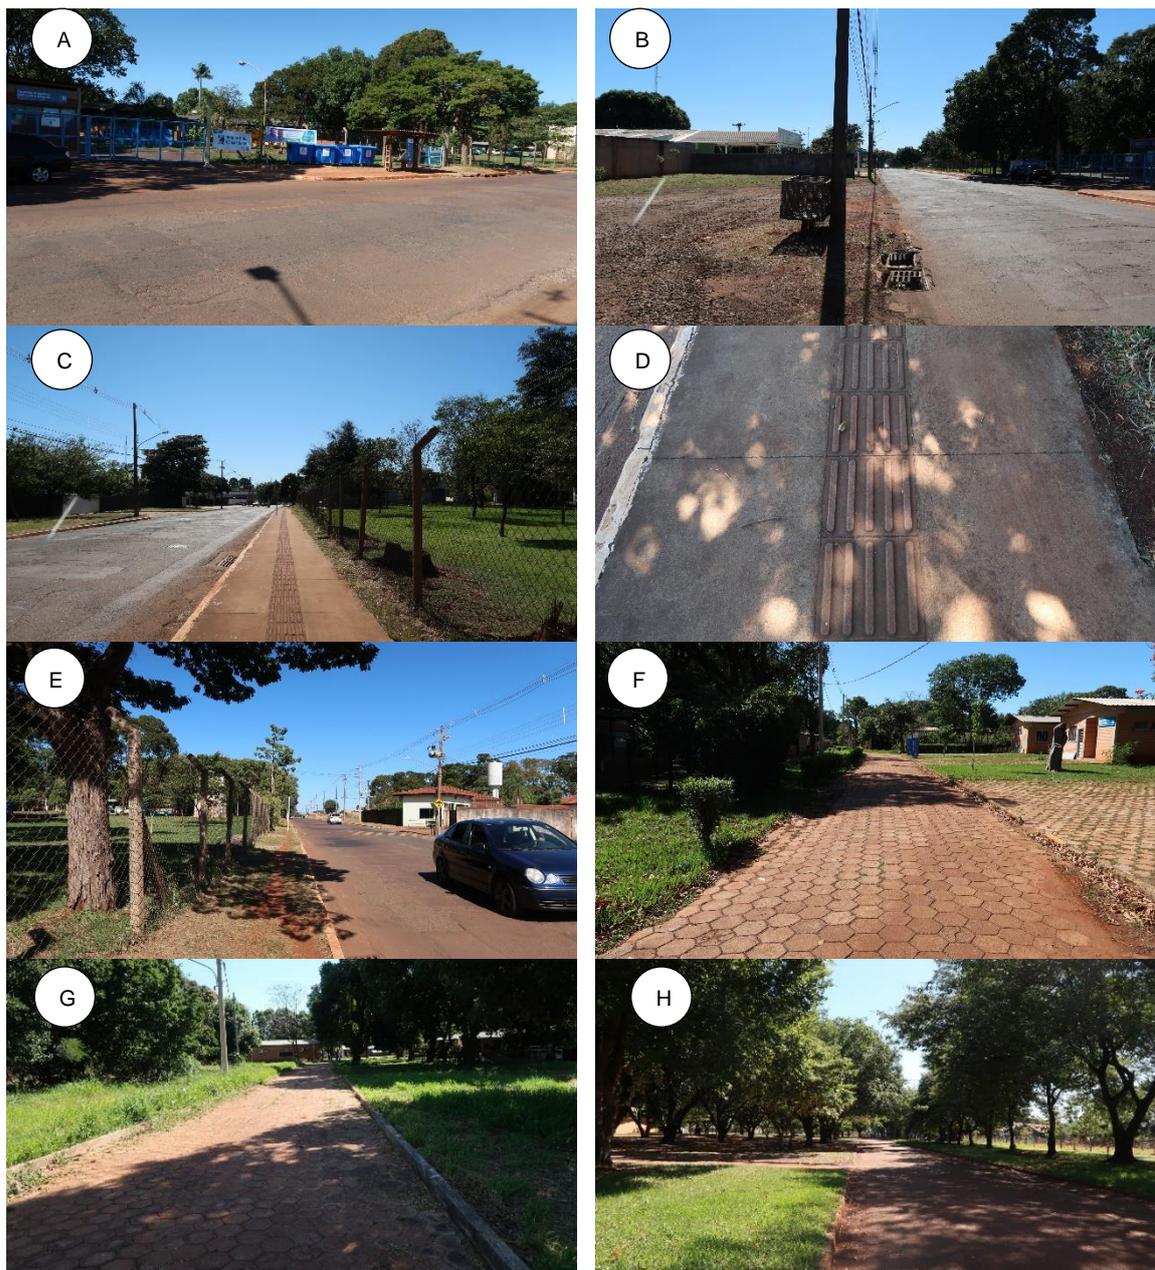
Levantamento Fotográfico do Setor 4 do Campus Campo Grande da UFMS e imediações. A – Vista da entrada da FAMEZ, instalação localizada no Setor 4, onde nota-se a necessidade de sinalização horizontal viária. B – Vista da Avenida Senado Filinto Müller, margem da via do lado oposto ao da FAMEZ, onde é possível constatar carência de vegetação, sinalização e de passeio. C - Presença de piso tátil na calçada frontal à entrada da FAMEZ. D - Vista de piso tátil em detalhe na calçada em frente à FAMEZ, evidenciando a necessidade de conciliar os diferentes interesses dos usuários de espaço construído. E- Vista da Avenida Senado Filinto Müller, evidenciando a heterogeneidade de cobertura do passeio. F- Vista interior do setor 4, onde é evidenciada a ausência de diferenciação entre passeio e via. G – Via interior ao setor 4, com ênfase para a ausência de calçada. H- Vista interior do setor 4, com ênfase à qualidade da pavimentação da via e ao porte robusto da vegetação, a qual propicia sombreamento.
